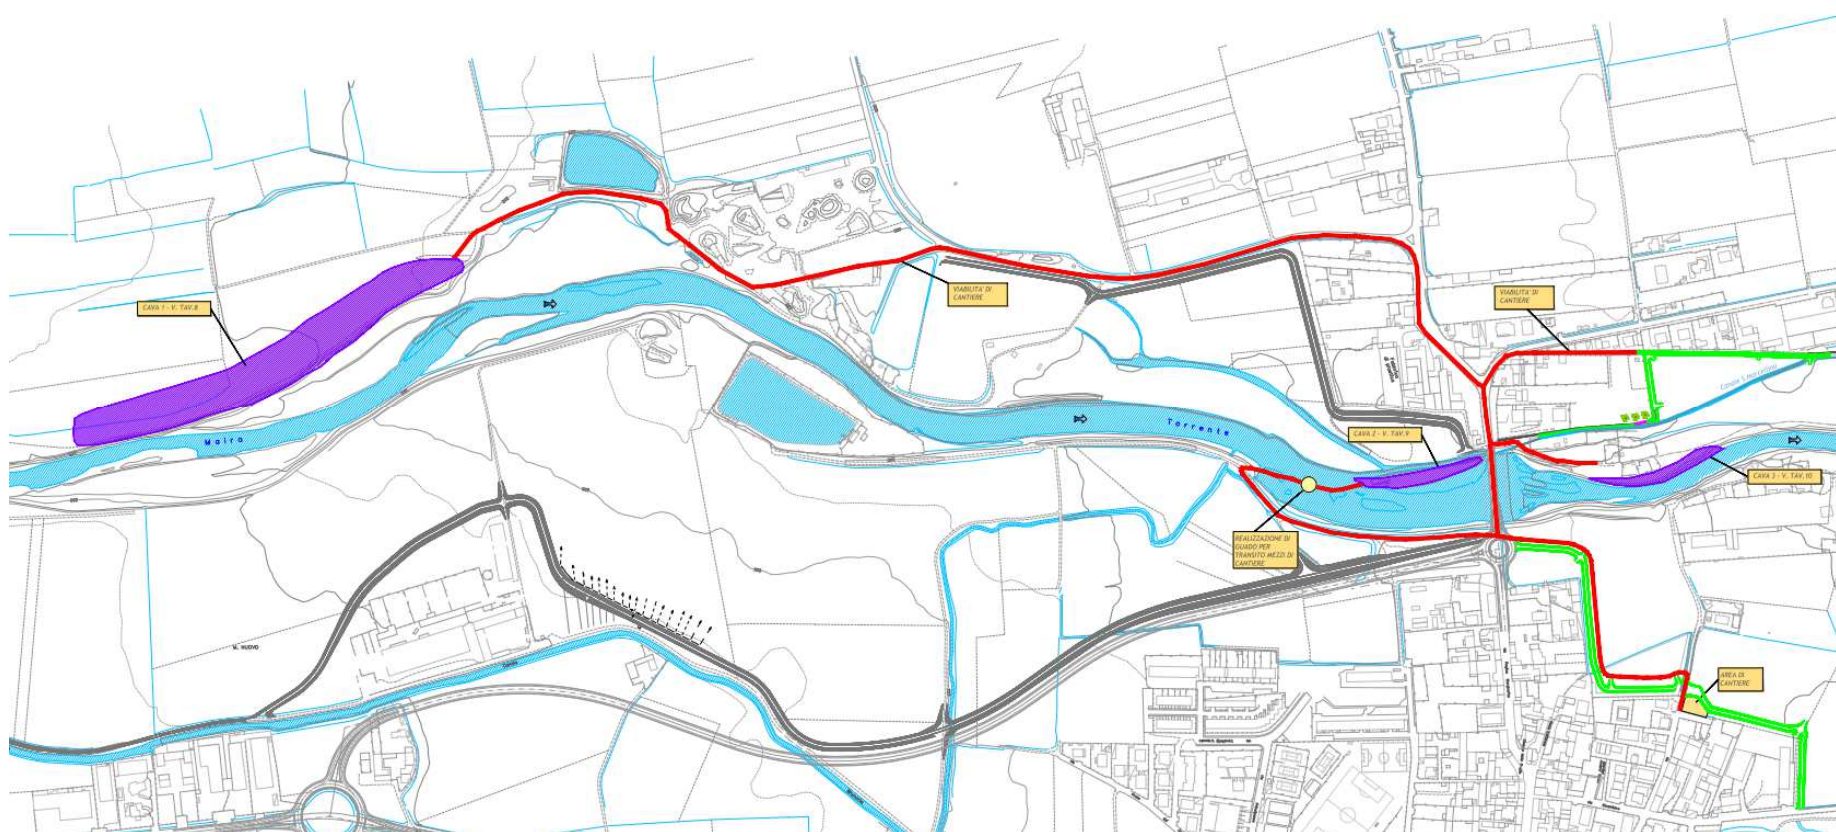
ESTRATTO DELLA TAV. 13 PLANIMETRIA AREE E VIABILITÀ DI CANTIERE
